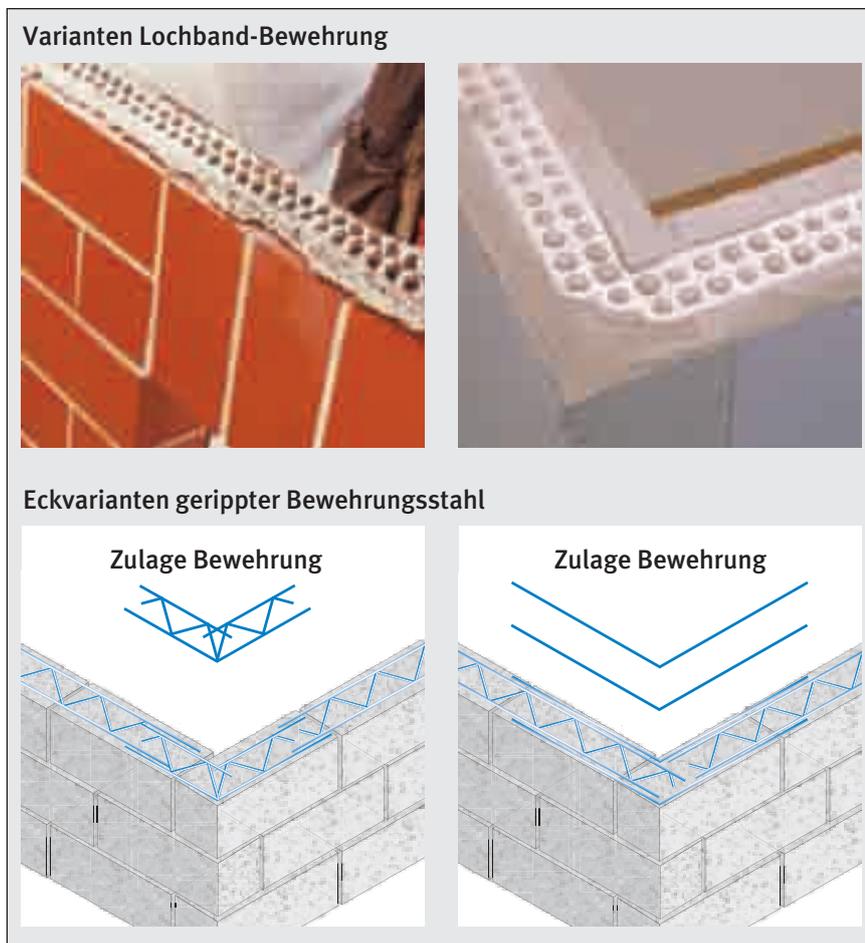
Konstruktive Lagefugenbewehrung, Anwendungsbeispiele
